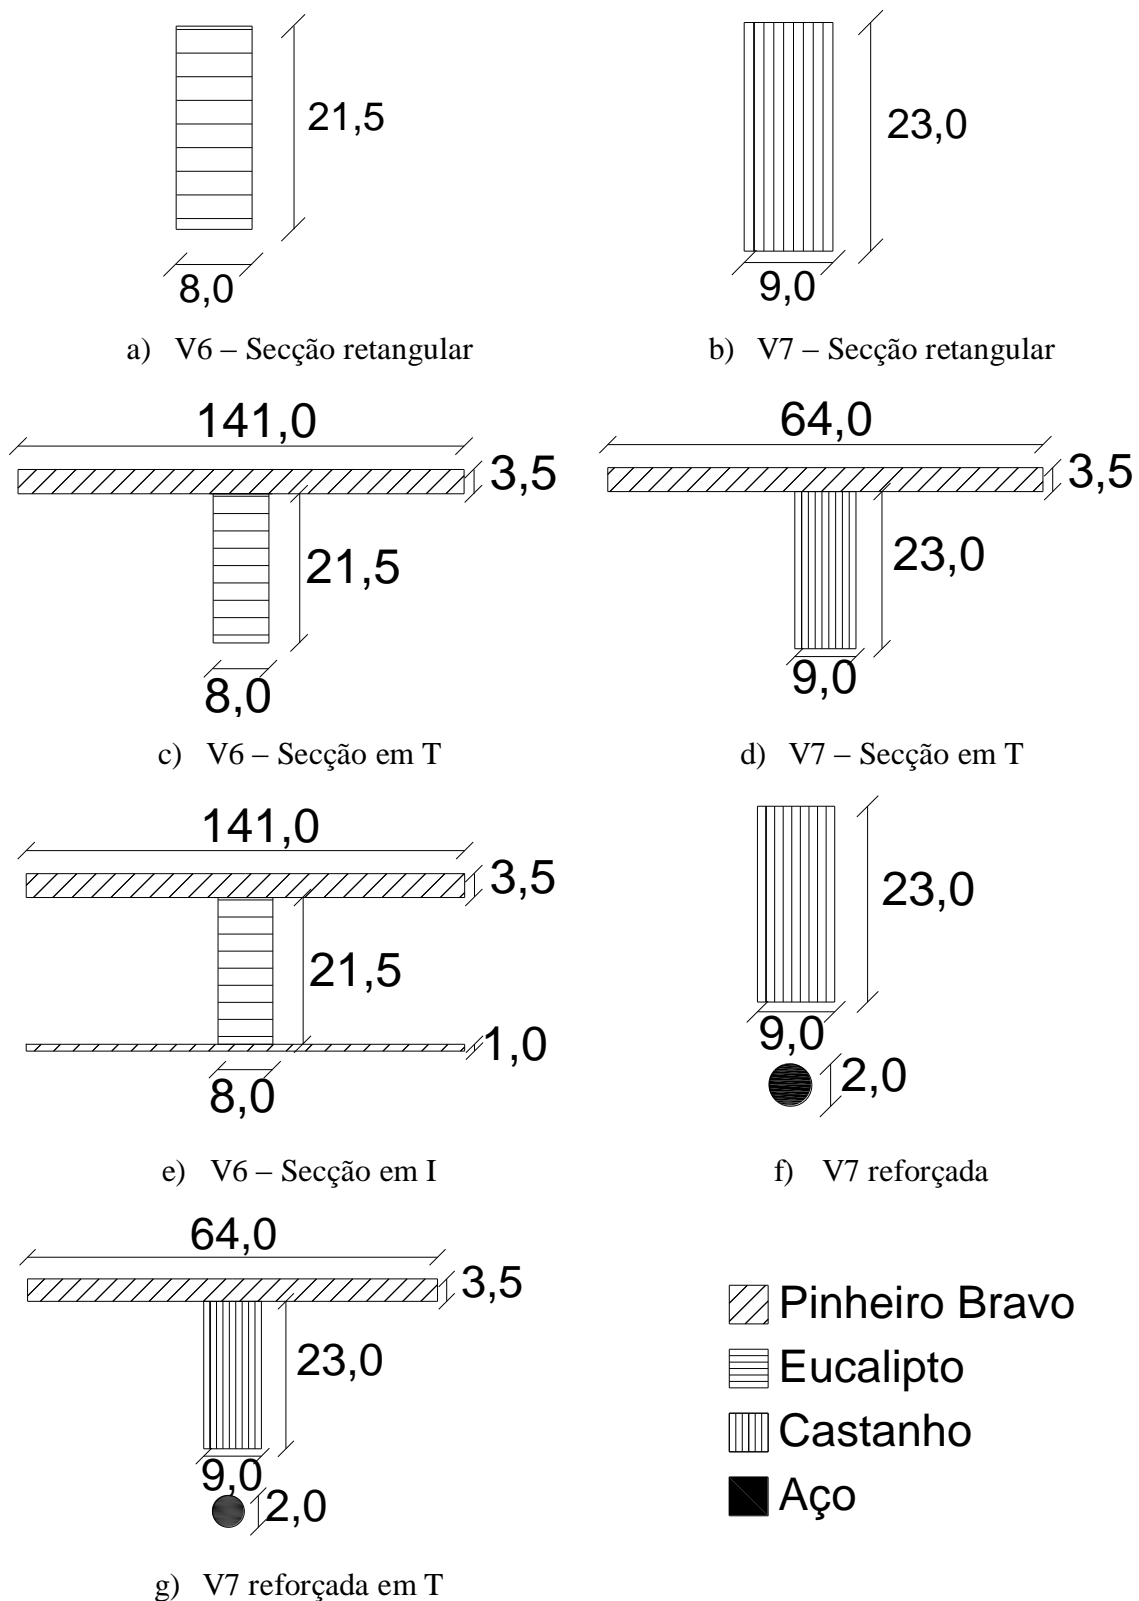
Secções transversais consideradas nas vigas V6 e V7 (cm)
